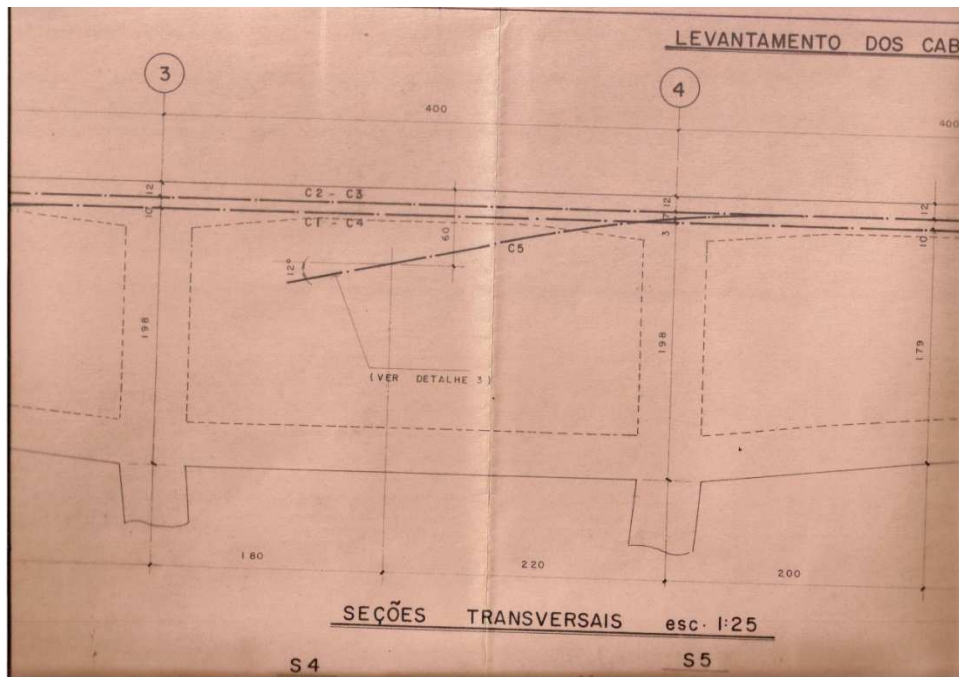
Corte Longitudinal – Região do Apoio (cm)
